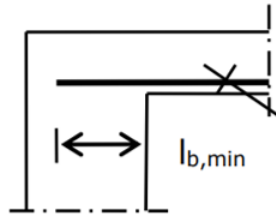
Amarração de armadura inferior em apoio de encastramento (Félix et al., 2014)
